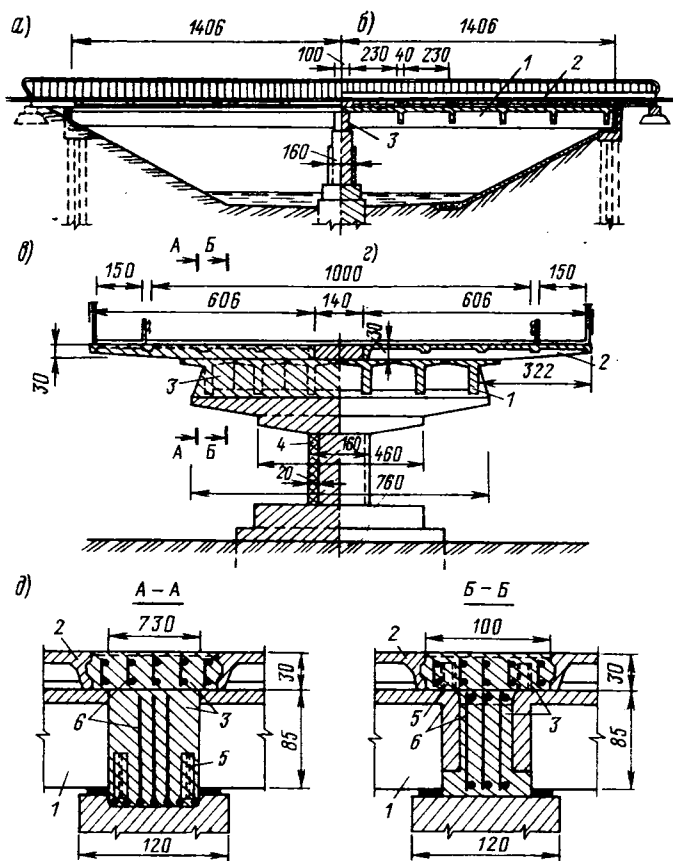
Реконструкция моста через р. Верещица в Львовской обл.: а — фасад моста; б — разрез по оси; в — сечение по опоре; г — сечение в пролете; д — сечение добетонированной части ригеля;
